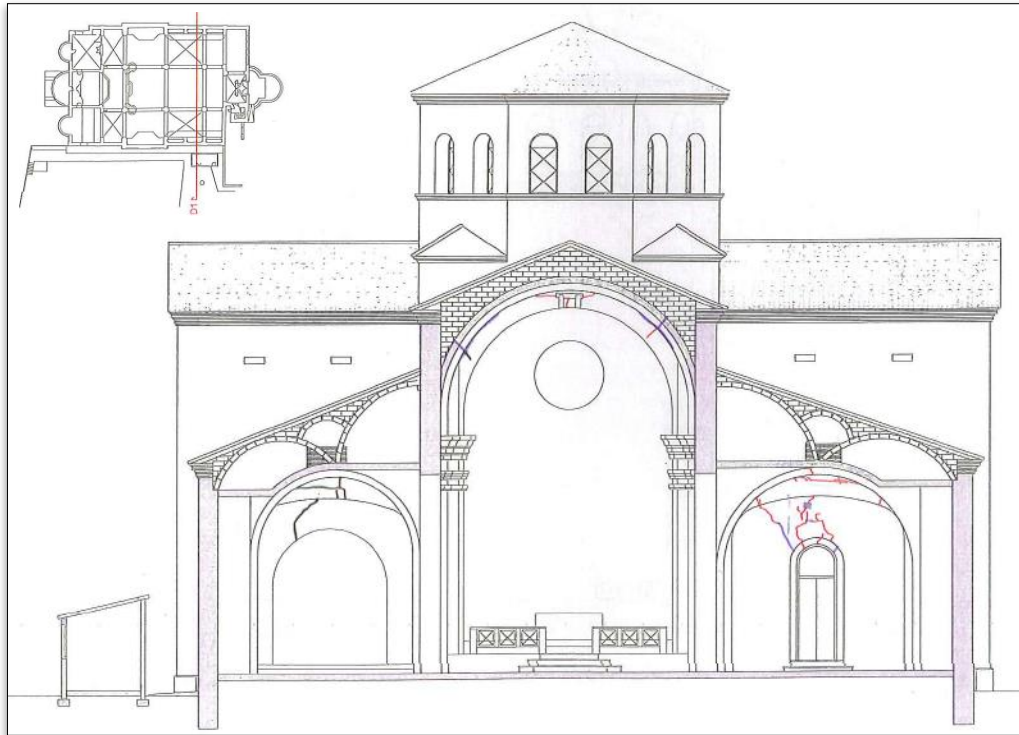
Grietas sección transversal sur (plano PAT. 07)
